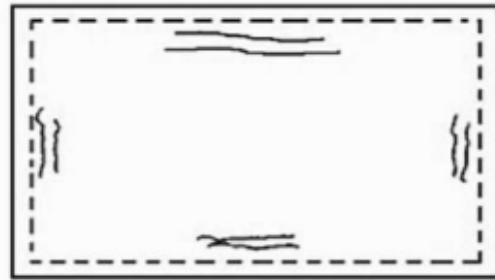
Fissuração de flexão, devida à insuficiência de armadura para os momentos negativos. As fissuras surgem na face superior.
